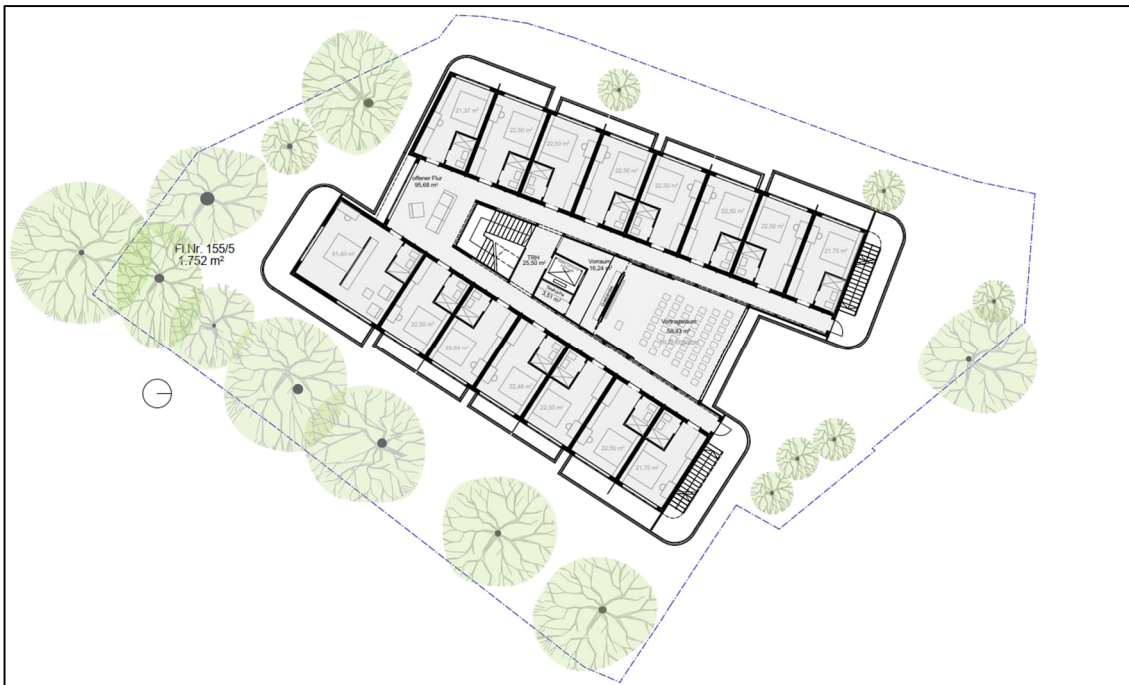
Grundriss 2. Obergeschoss des Vorhabens /40/
